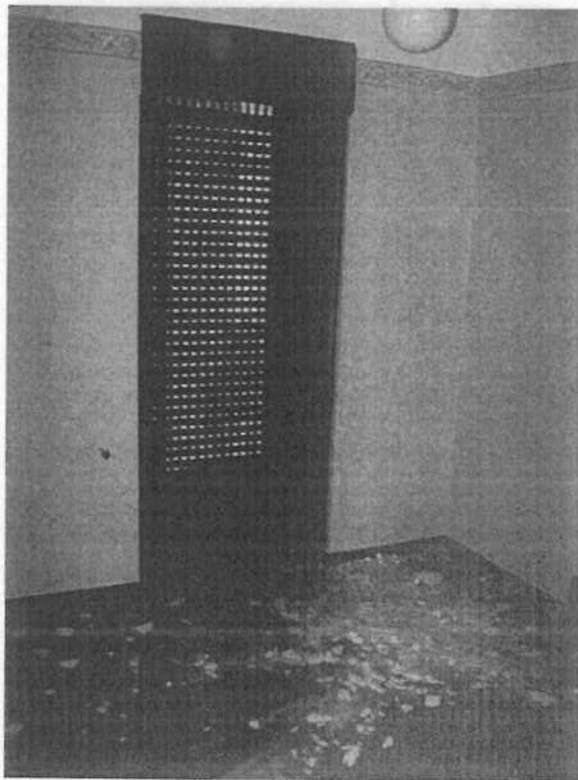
Calcinacci caduti dal soffitto nella camera al piano primo.
